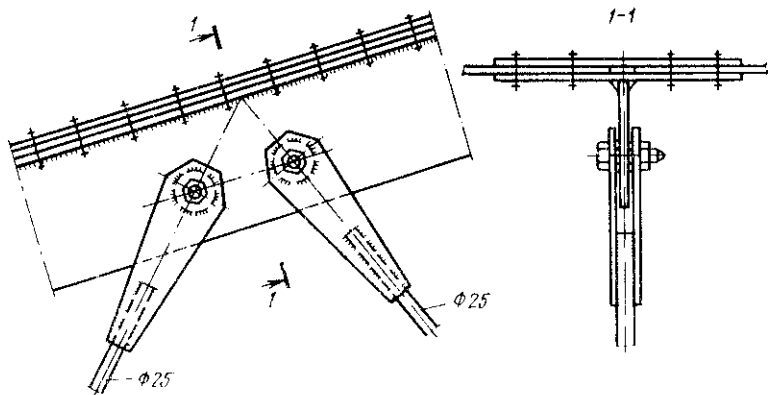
Направляющие полосы для монтажа мембраны и крепление подвесок
